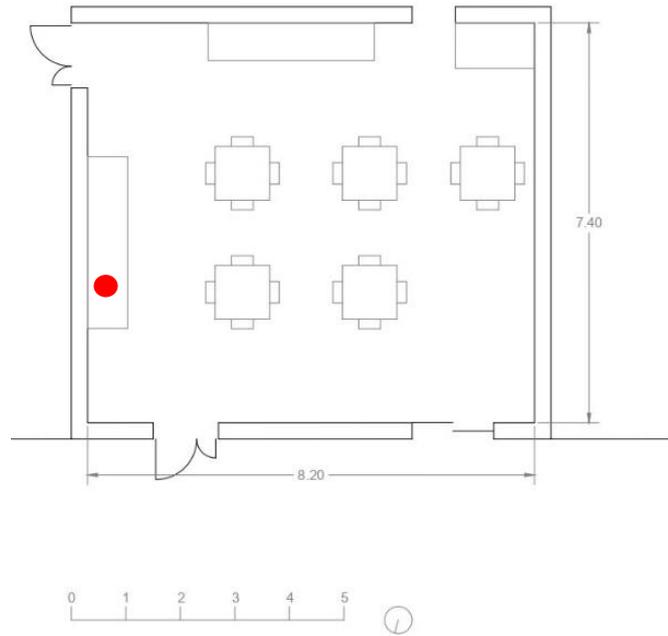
Ubicación del dispositivo en caso B. Fuente: elaborado por el autor. (Imagen y plano)
